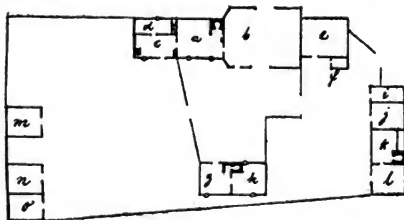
Grundriss eines estnischen Bauerhofes. S:t Johannis (Oesel). Riga.
